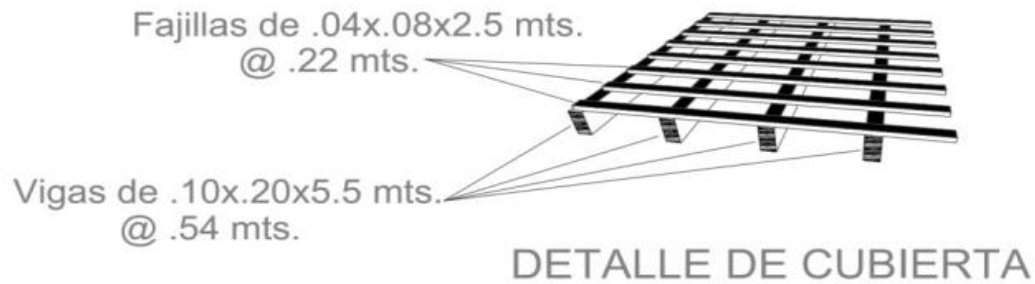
Detalle de cubierta, mostrando las vigas y fajillas a utilizar (Ver apartado VIII. 1. 1).
